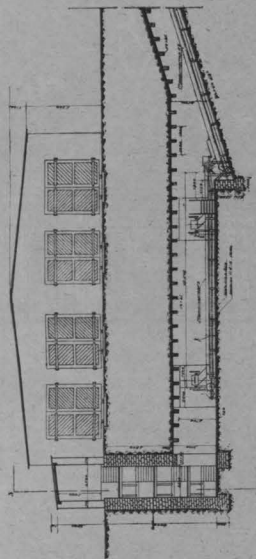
Склад концентратов. (План фундаментов, продольный и поперечный разрез)
